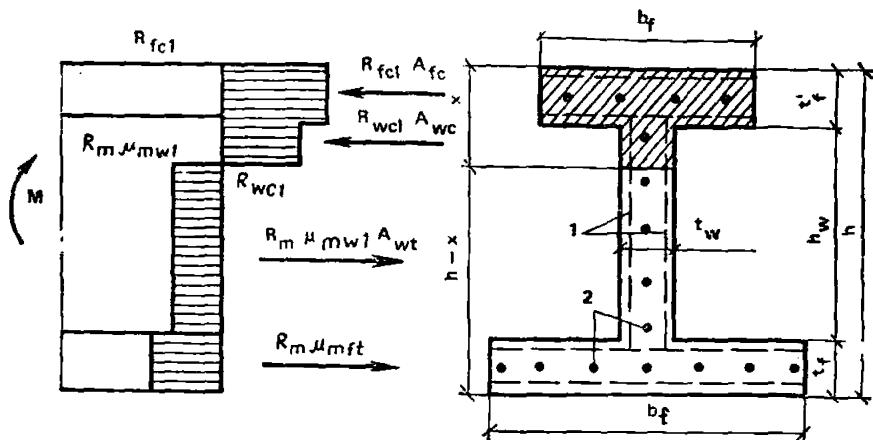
Схема усилий и эпюра напряжений в изгибаемых элементах двутаврового сечения при $x > l_f'$
